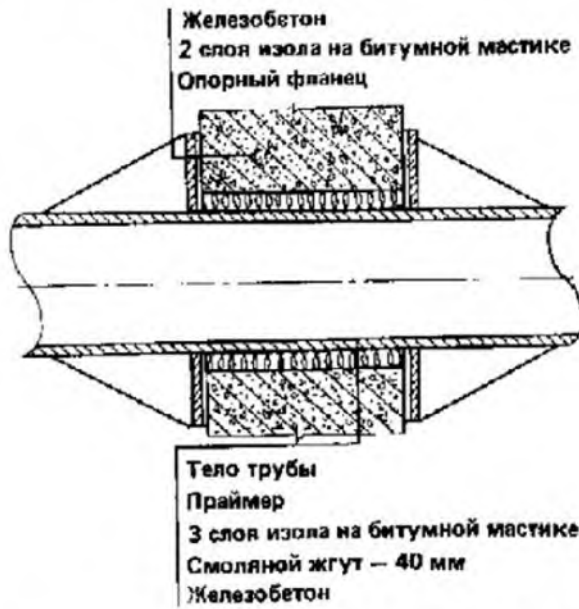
Изоляция трубопровода в футляре неподвижной опоры
